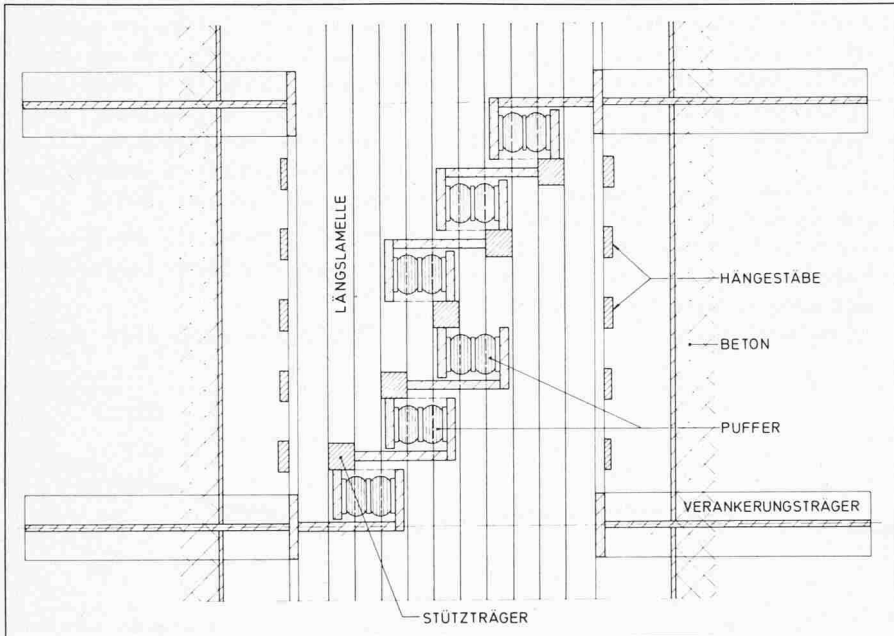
Grundriss oben durch Puffer bei Fahrbahnübergang, Koppelfuge
